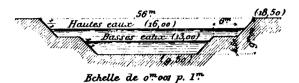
Section en travers du rayah Tewfikieh à la prise.
